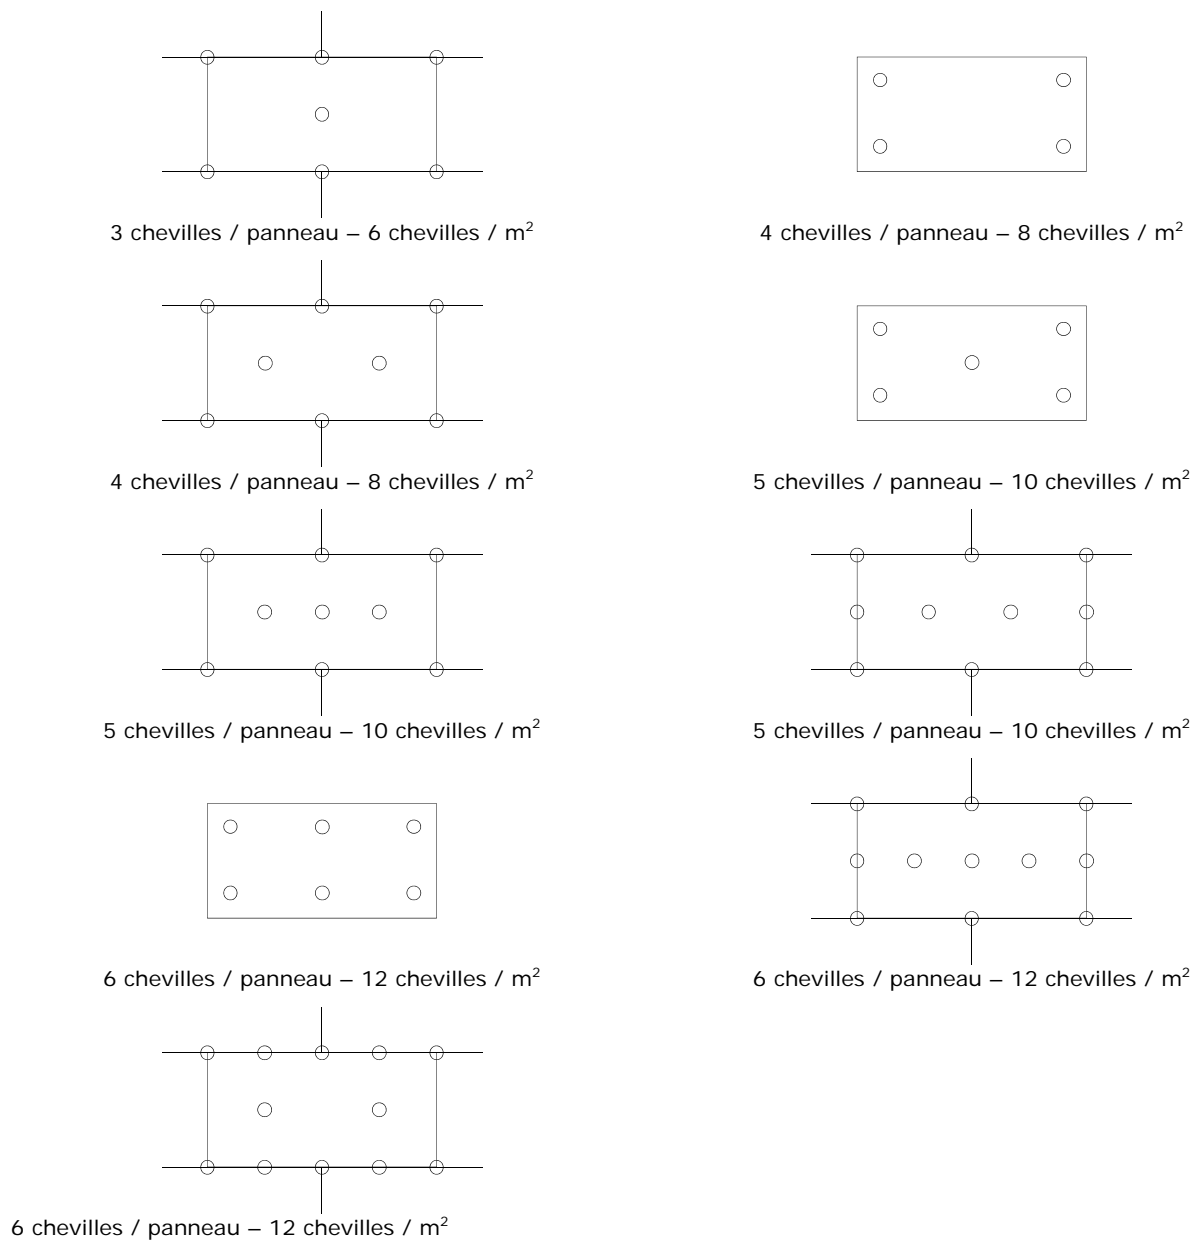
Plans de chevillage - panneaux de dimensions 1000 x 500 mm
